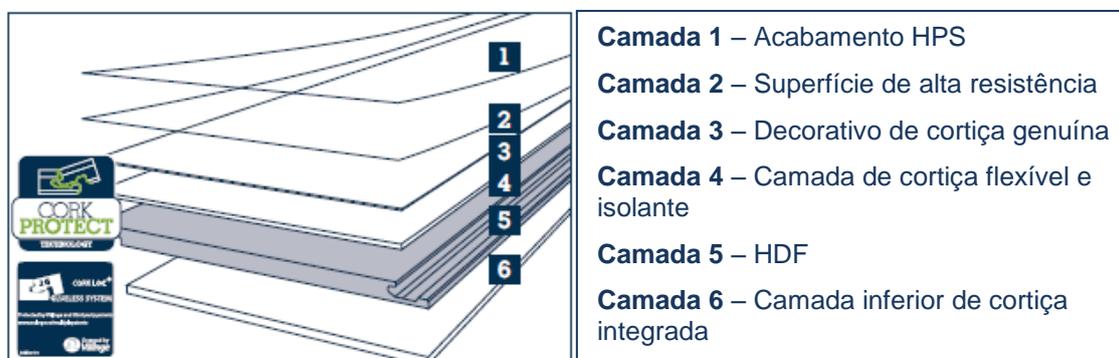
Constituição do Pavimento Flutuante com HPS [4]
